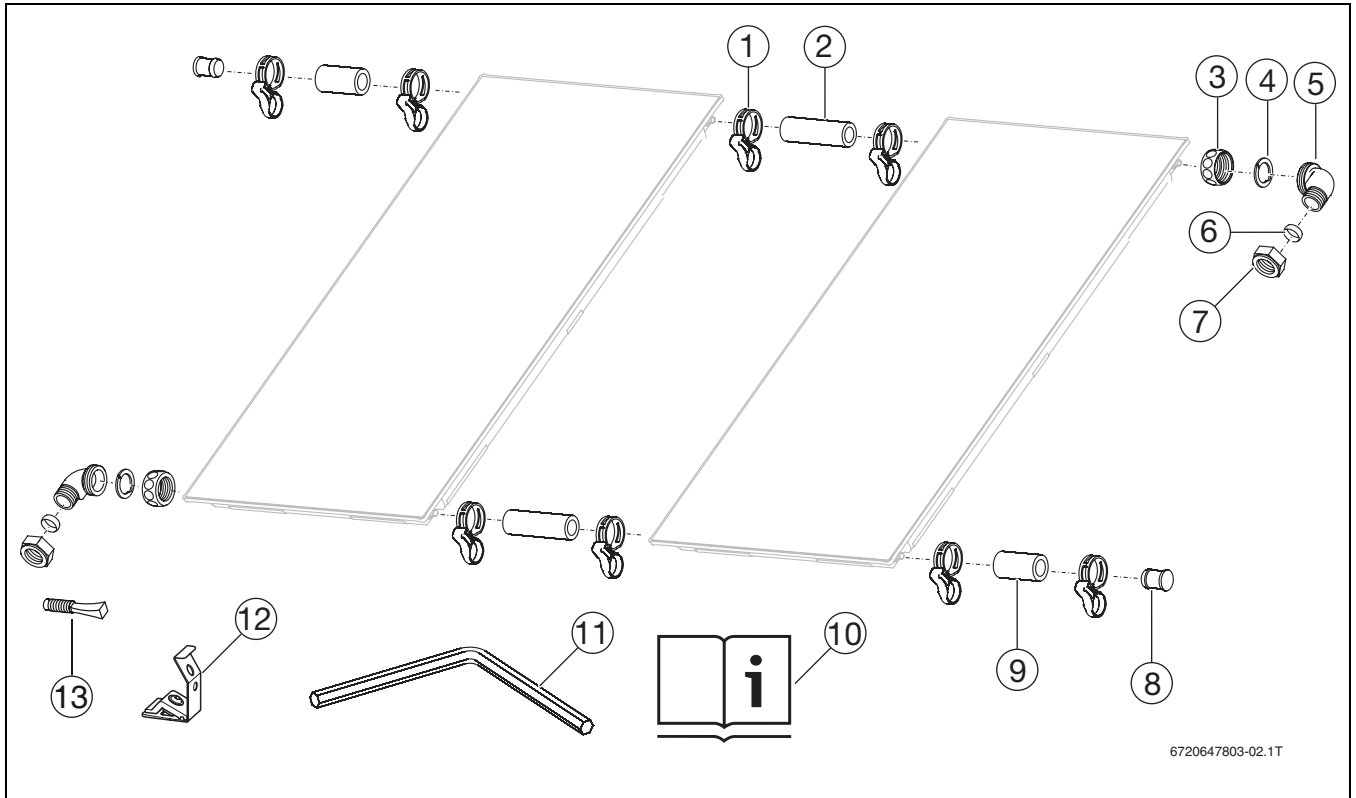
1 conjunto de ligação no telhado plano e 2 módulos de ligação
